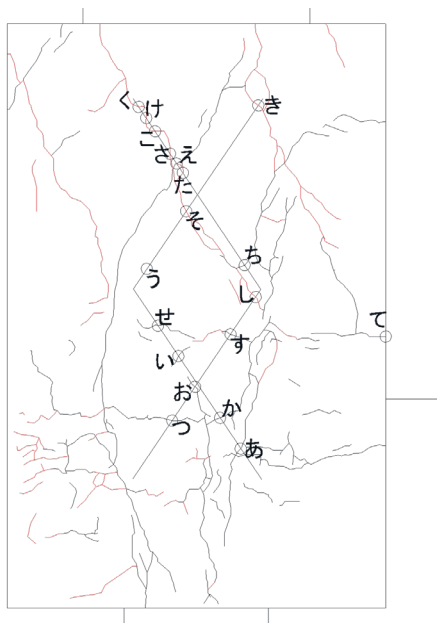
パイルキャップひび割れ幅測定位置 (試験体 D-1 負荷荷)
